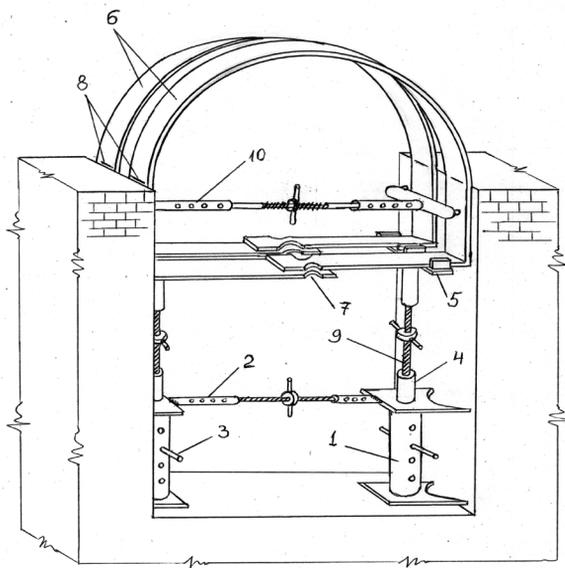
Установка приспособлений для возведения арки: 1 – основная труба телескопической стойки; 2 и 10 винтовые упоры; 3 – стержни – фиксаторы для «грубой» установки высоты стоек; 4 – подвижная труба телескопической стойки; 5 – опорные пластины для кружал; 6 – секции «пружинных» кружал; 7 – замок кружал; 8 – риски для выверки кружал; 9 – винтовые стержни для «тонкой» установки высоты стоек.
